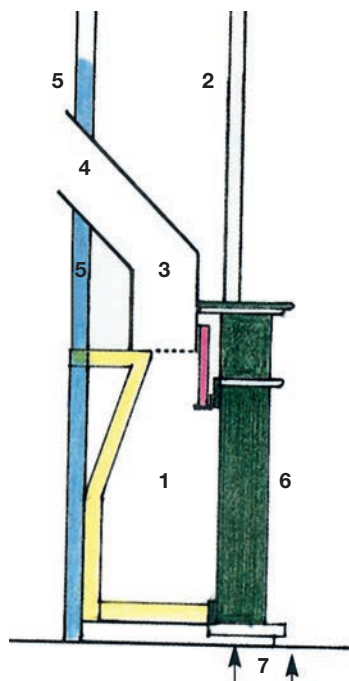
Secțiune (pe schița structurală se pot observa fațada, spațiul de ardere și țeava de fum)
